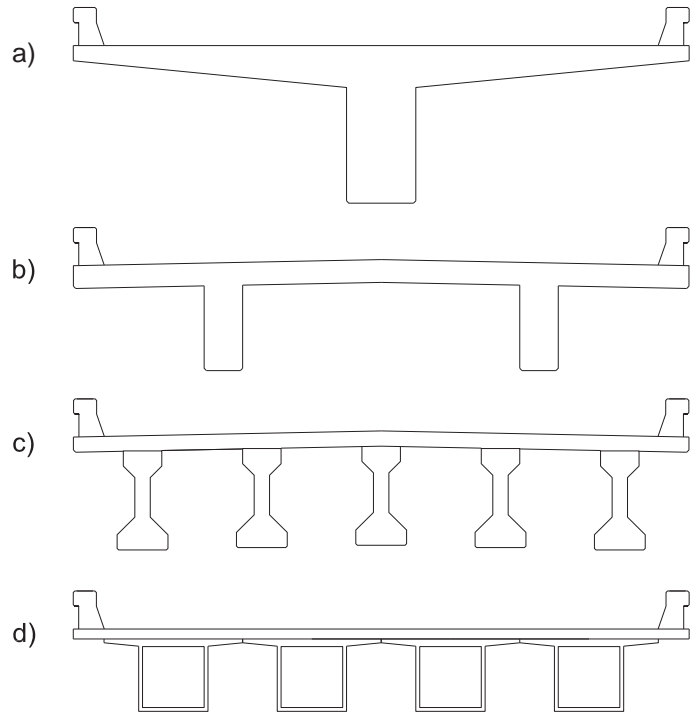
Secciones transversales de losas apoyadas sobre vigas: a) Losa sobre una viga rectangular, b) Losa sobre dos vigas rectangulares, c) Losa sobre vigas tipo AASHTO, d) Losa sobre vigas tipo cajón
